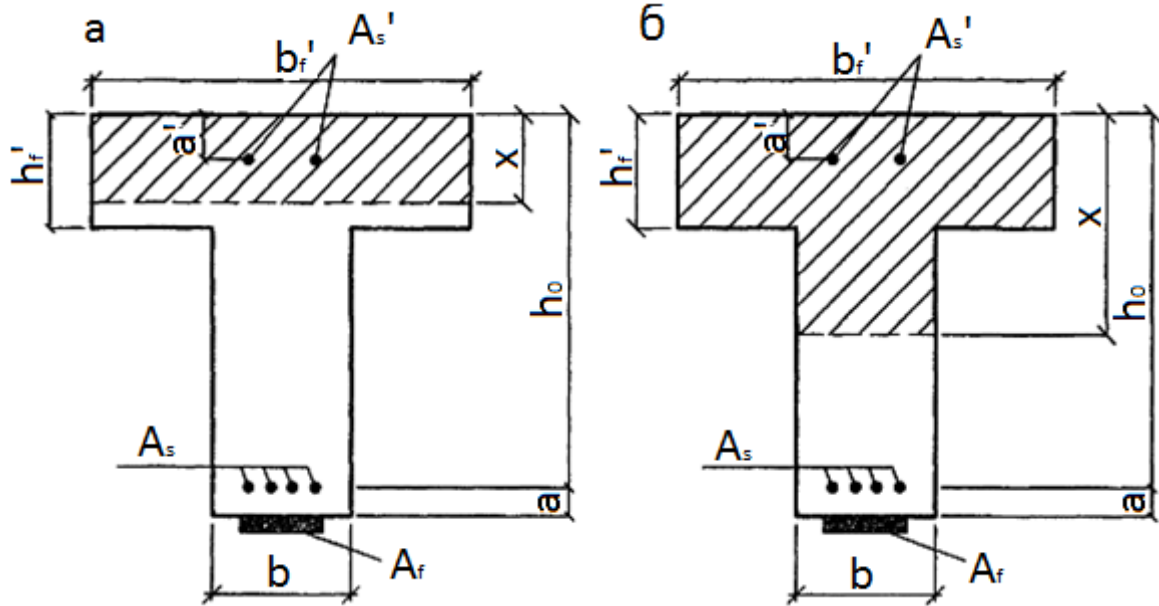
Схема расположения границ сжатой зоны в сечении изгибаемого железобетонного элемента таврового профиля с внешним армированием из композитных материалов
